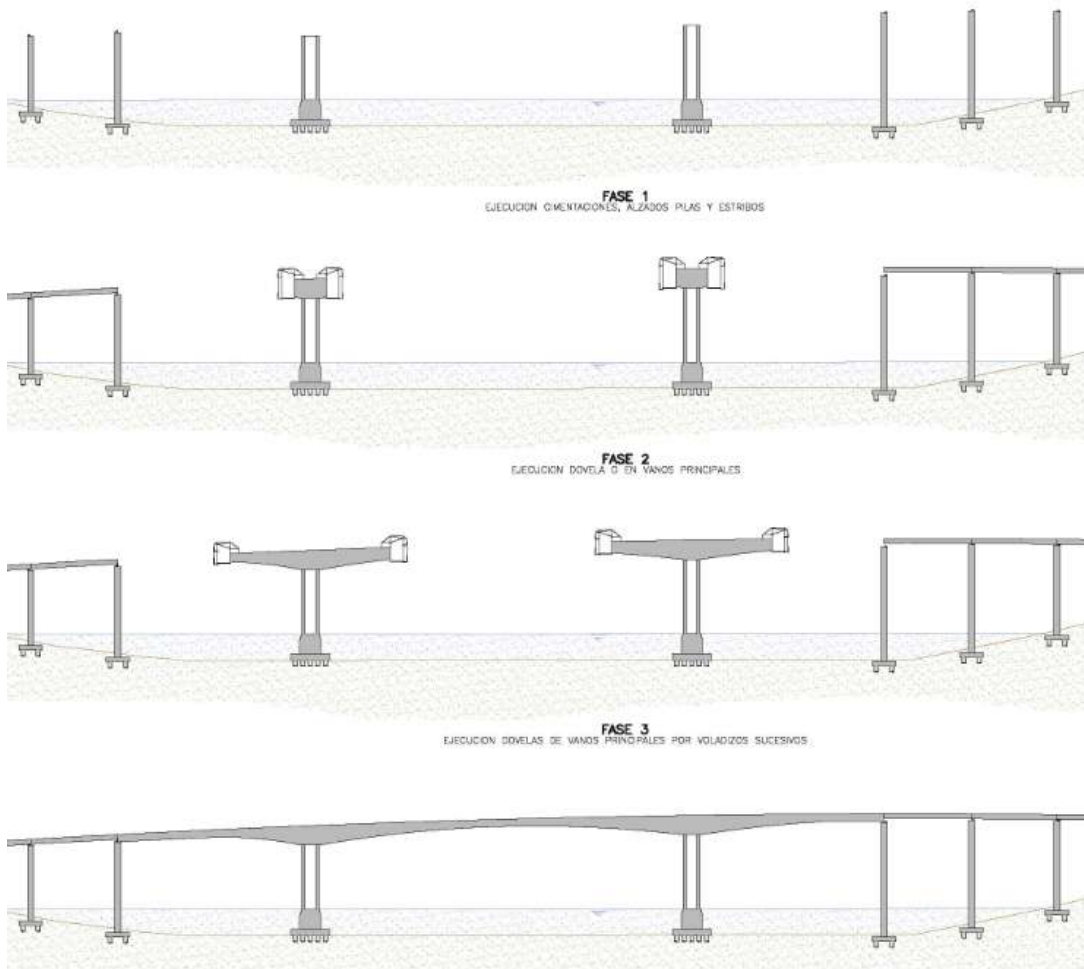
Esquema general del proceso constructivo por voladizos sucesivos.
